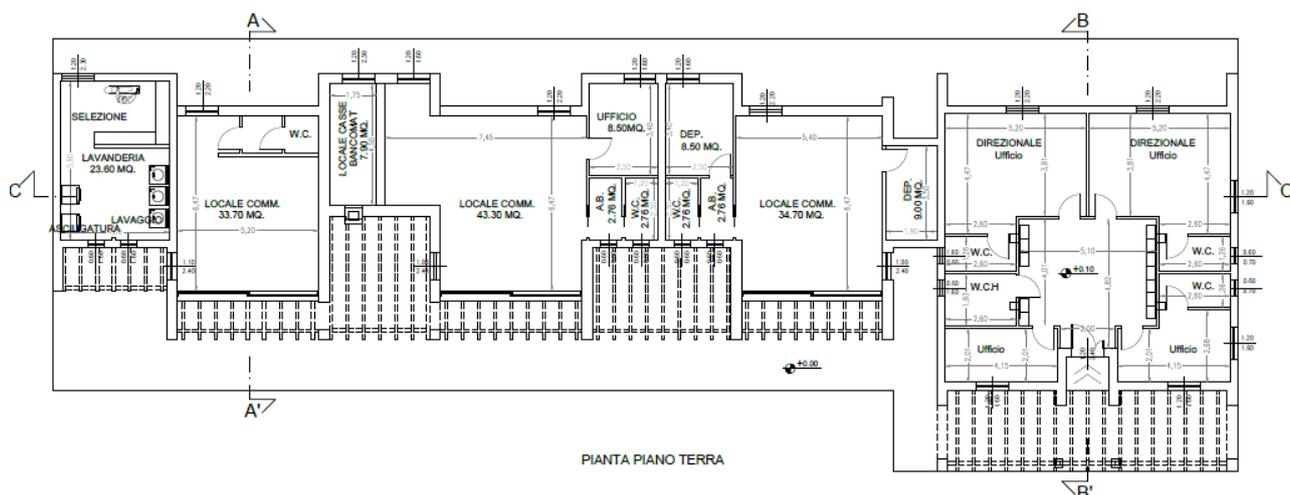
Planimetria edifici servizi portuali e spazi commerciali
